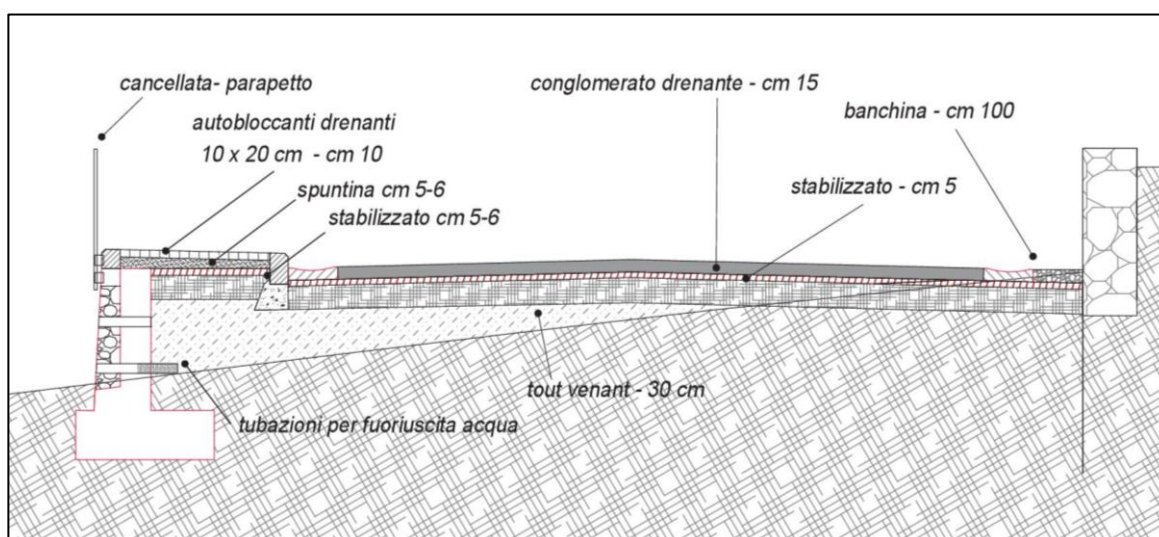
Sezione tipo sulla strada di lottizzazione in rilevato
